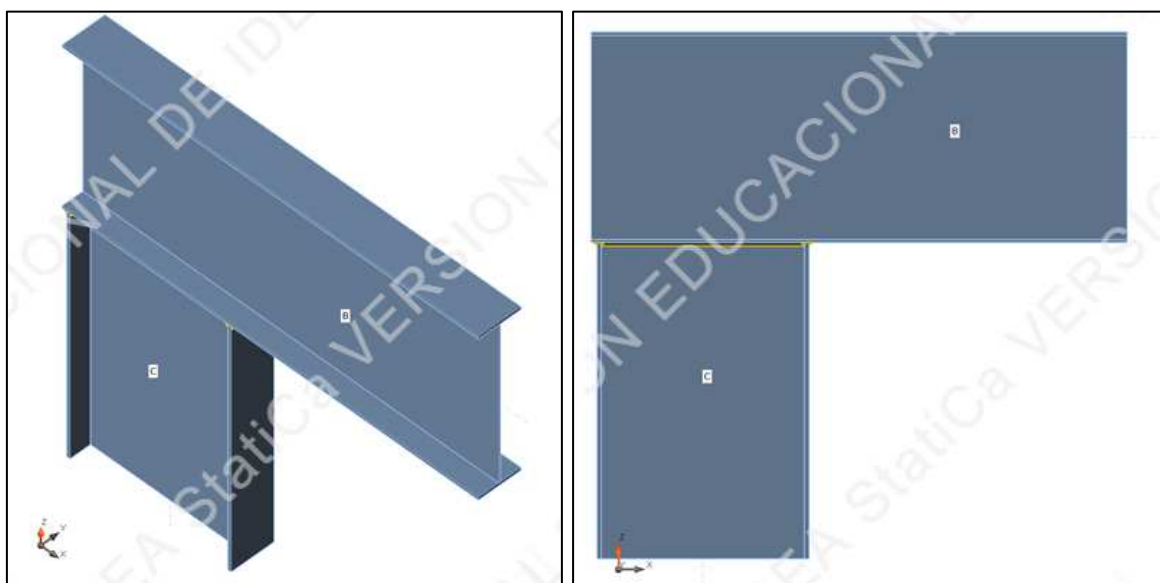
Modelo de unión soldada sin rigidizadores. Fuente: Autor.
